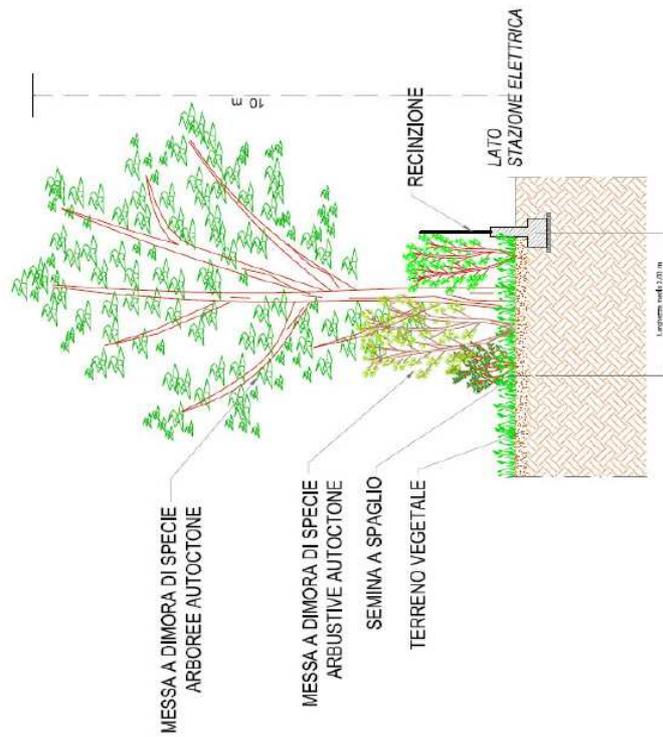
B- Planimetria Nuova stazione Udine Sud Alternativa con Formazione Fascia boscata
